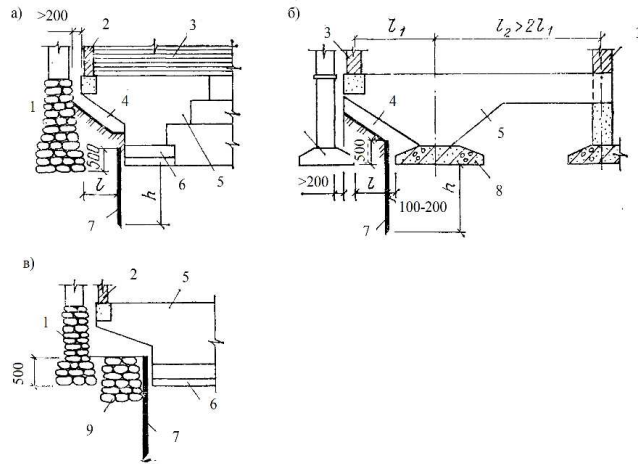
Консольне примикання фундаментів до існуючих конструкцій а)-з поздовжніми несучими стінами; б)- з поперечними несучими стінами; в) із збереженням фундаменту розібраної споруди; 1 – існуючий фундамент; 2 огорожжюча стіна; 3-несуча стіна; 4- зазор; 5-монолітна частина стіни фундаменту з консоллю; 6- розширення підшви фундаменту; 7- шпунт; 8- поперечний стрічковий фундамент; 9- частина будівлі, що збереглась
